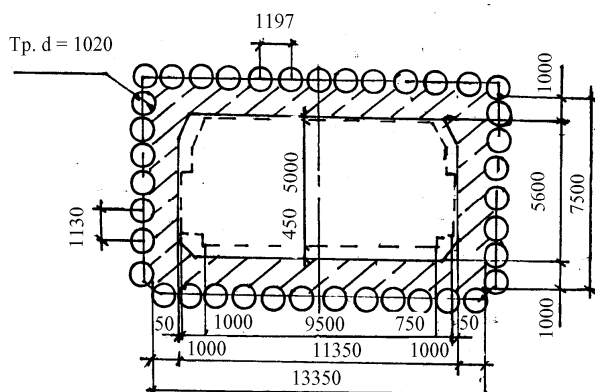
Схема тоннеля прямоугольного очертания с замкнутым контуром
